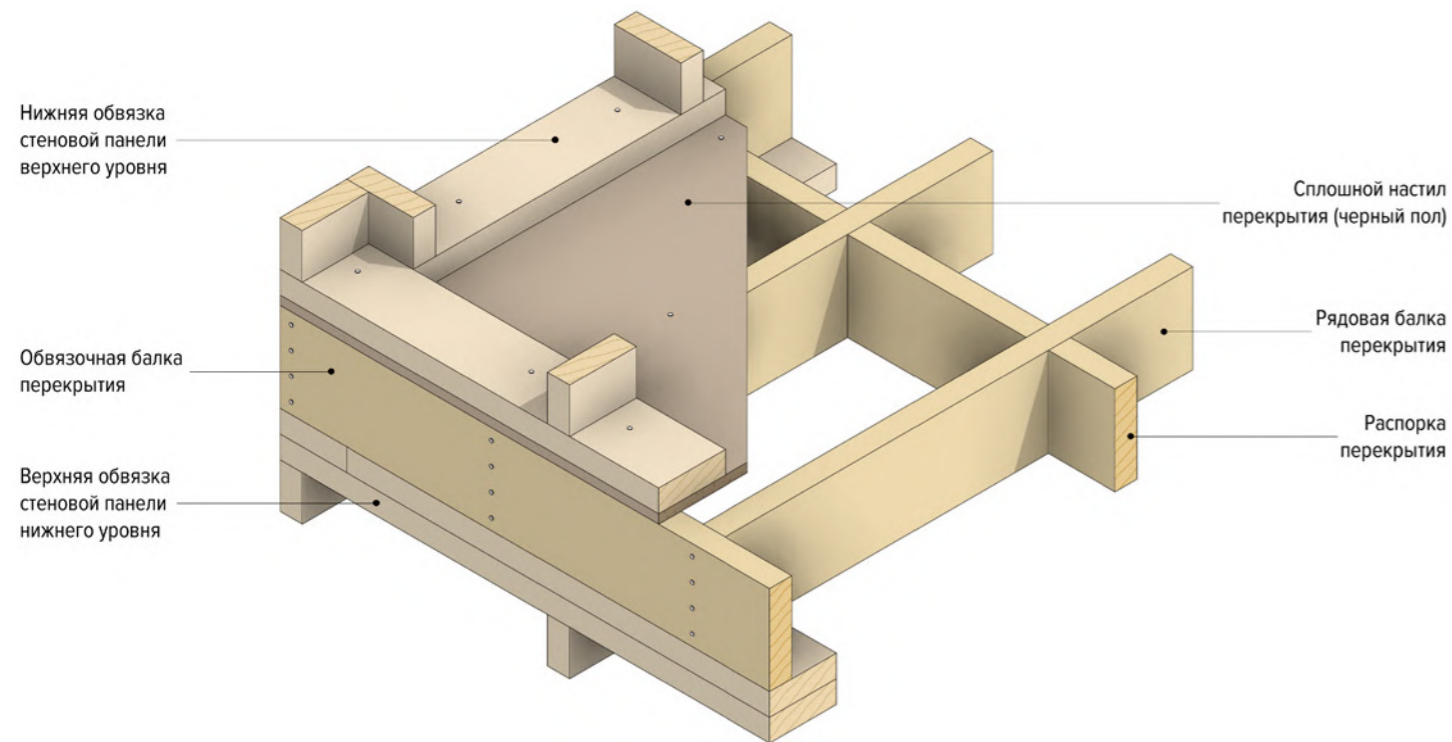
Основные конструктивные элементы каркаса перекрытия
